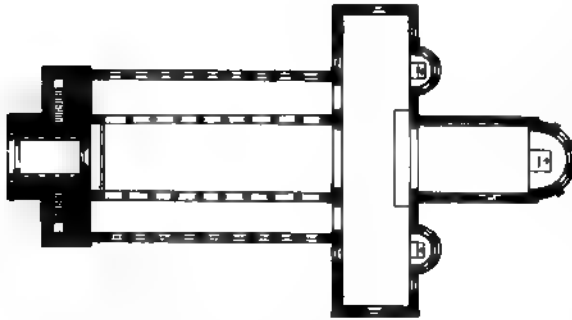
Grundriss der Klosterkirche zu Hersfeld
